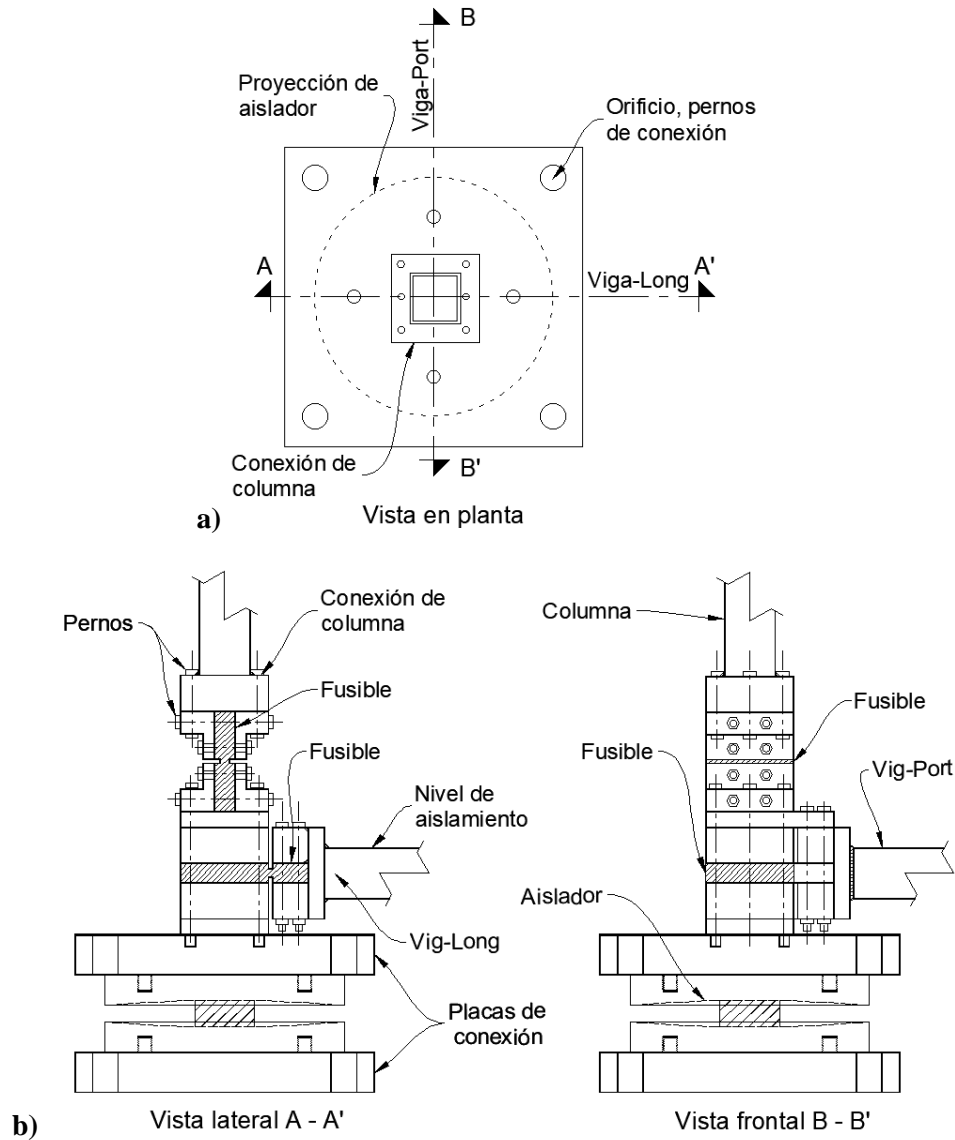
a) Planta tipo de conexión placa base-columna-aislador y b) Vista lateral y frontal
